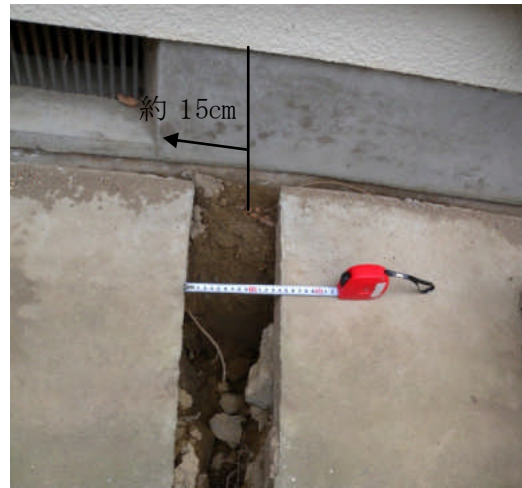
離間(基礎は外観上ひび割れ等なし)
